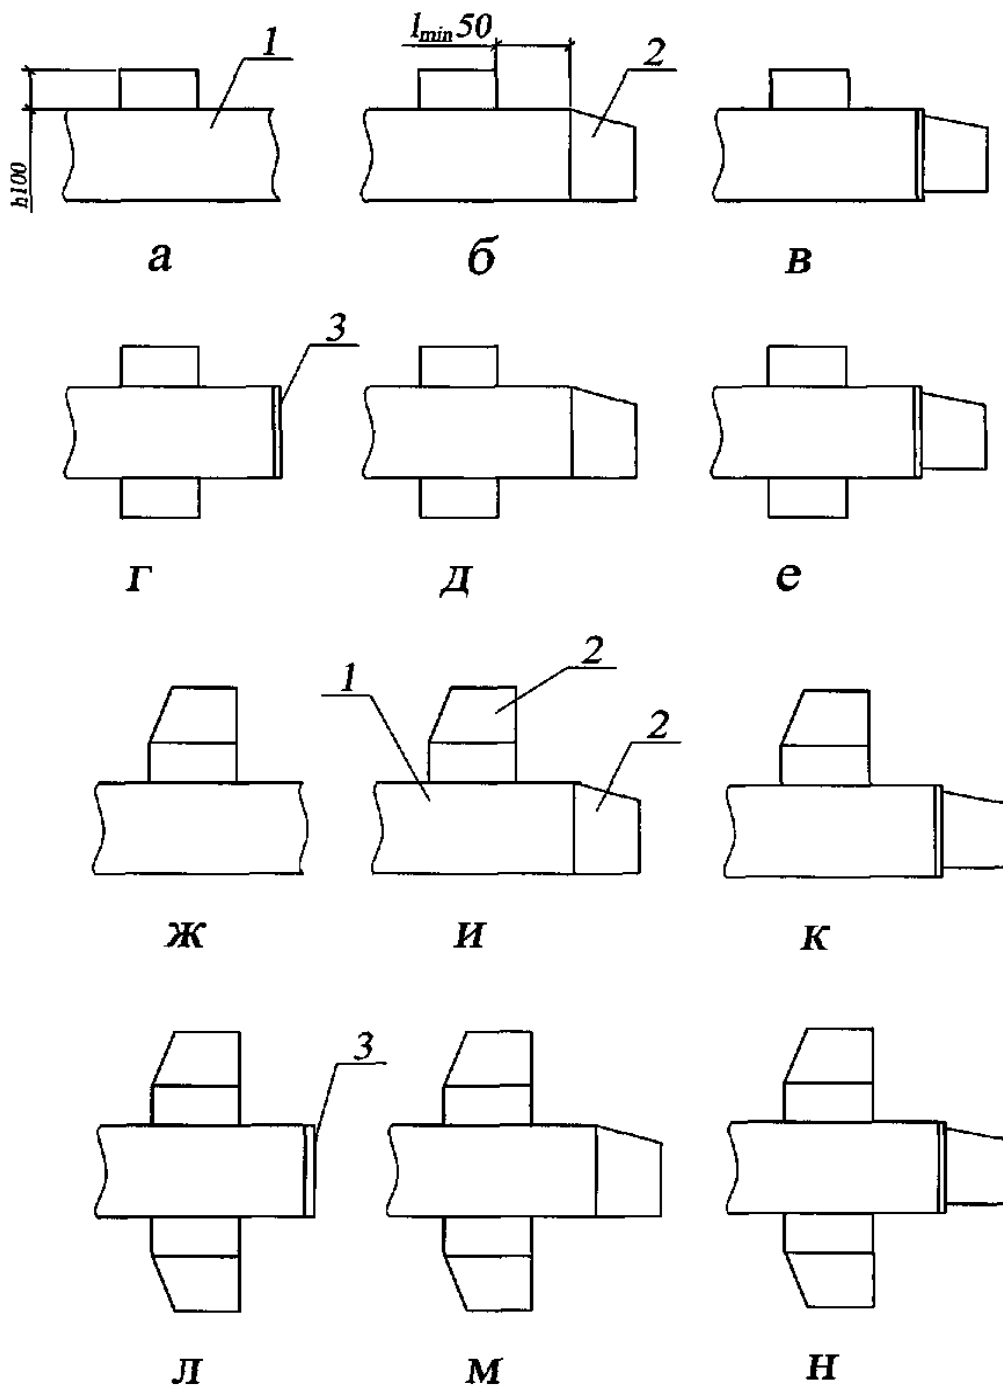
Схемы образования узлов ответвлений прямоугольного сечения:
